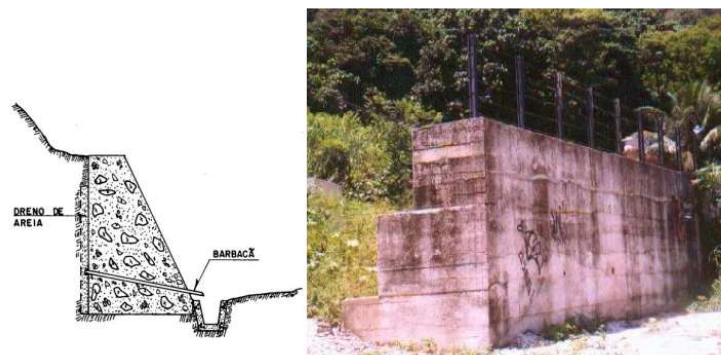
Muro de gravidade construído com concreto ciclópico. Fonte: GERSCOVICH ET AL (2016).
